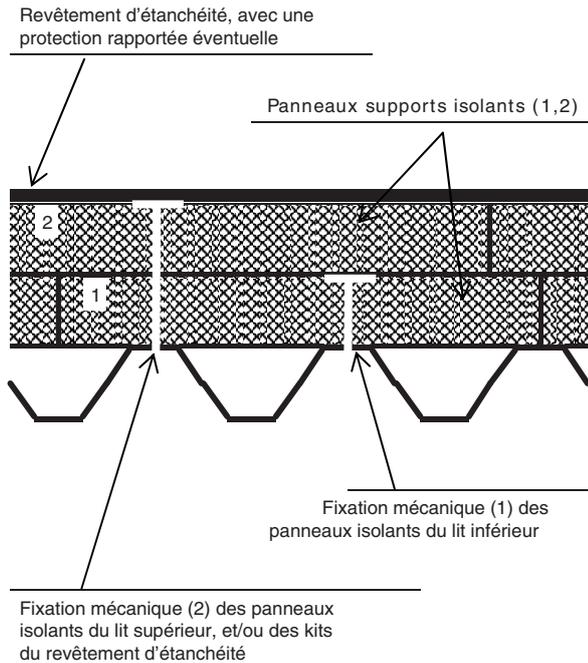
Coupe sur la toiture, avec une superposition de panneaux isolants
